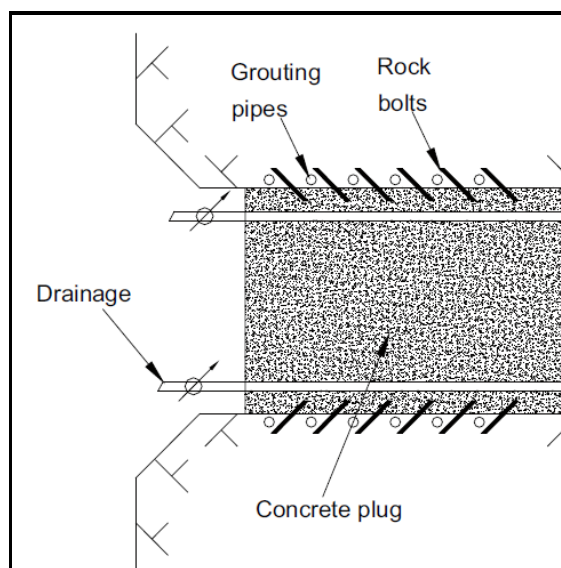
Tapón de hormigón con tubería de drenaje.
